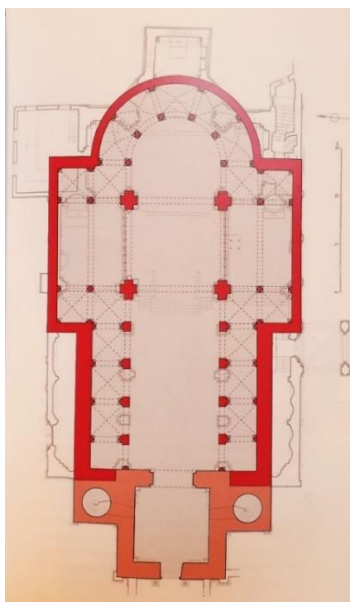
Grundriss Richezakirche, darunter der Neubau
